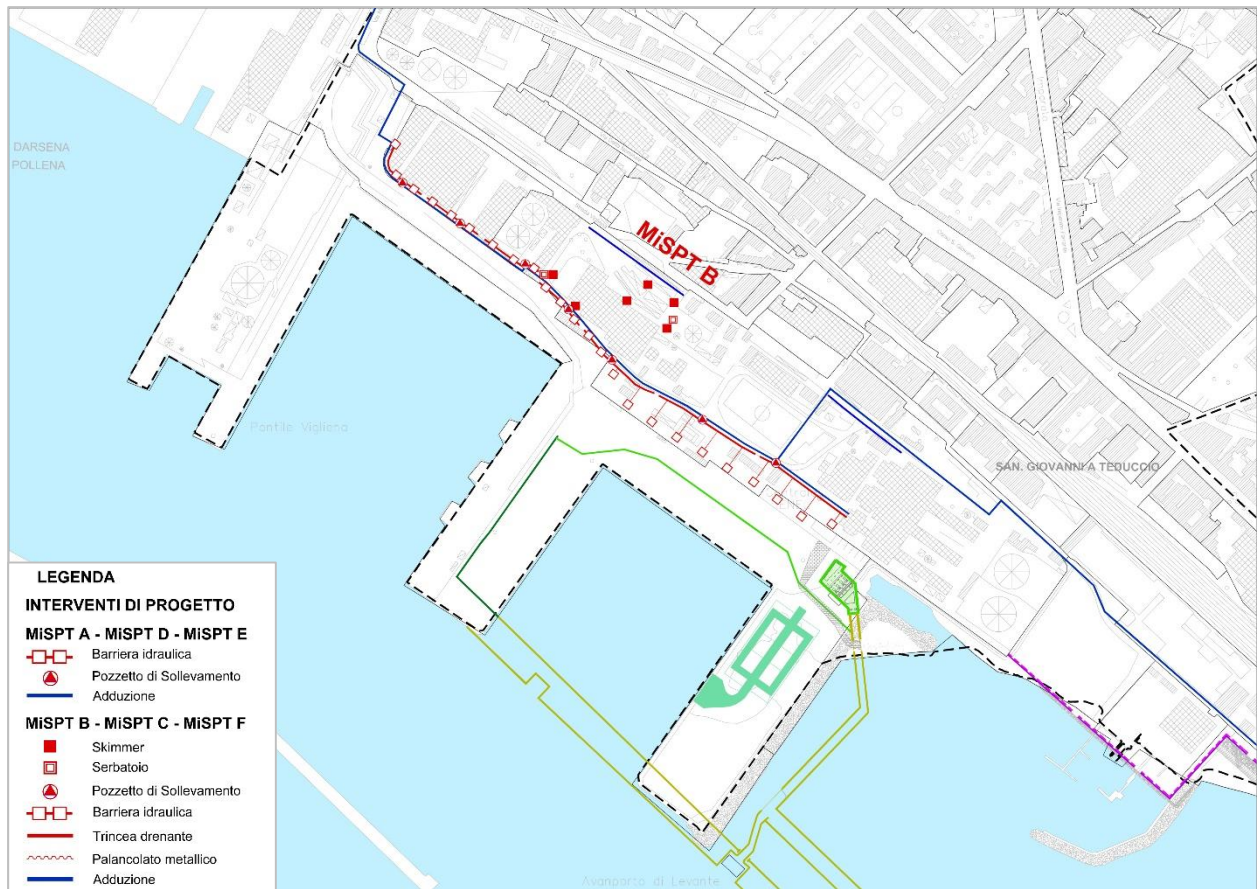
Area centro meridionale del SIN, interventi di progetto MiSPT B e MiS realizzate dalle aziende.
